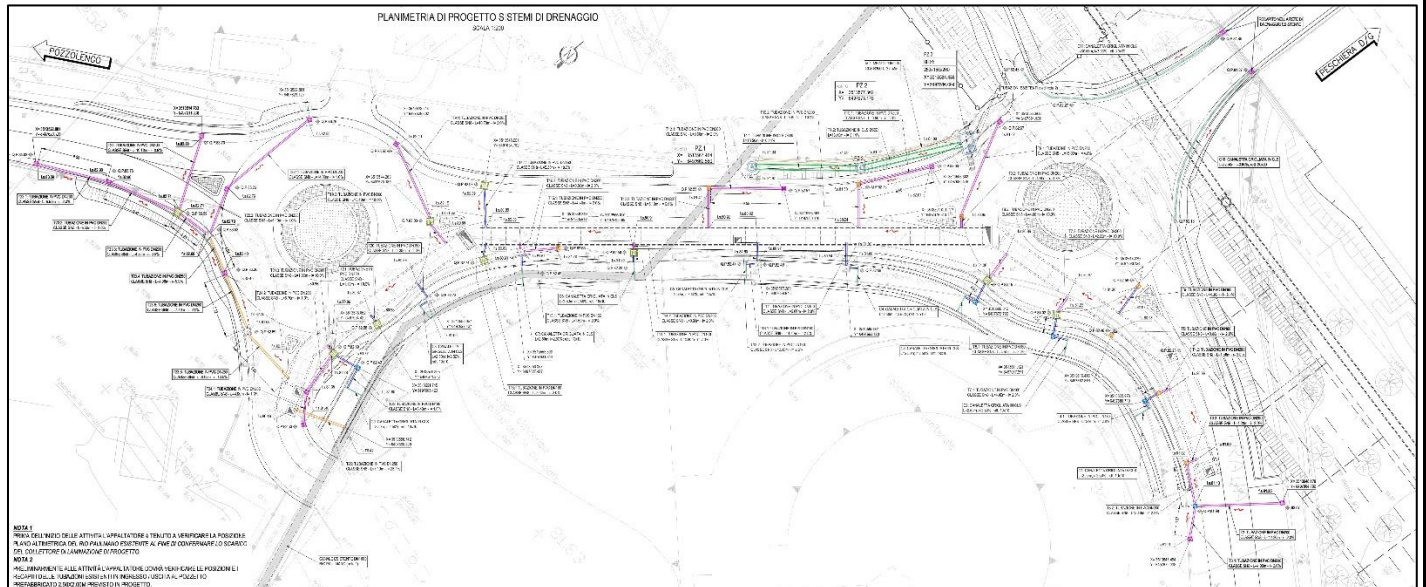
Estratto planimetria delle opere di drenaggio delle acque meteoriche dell'intervento di progetto
